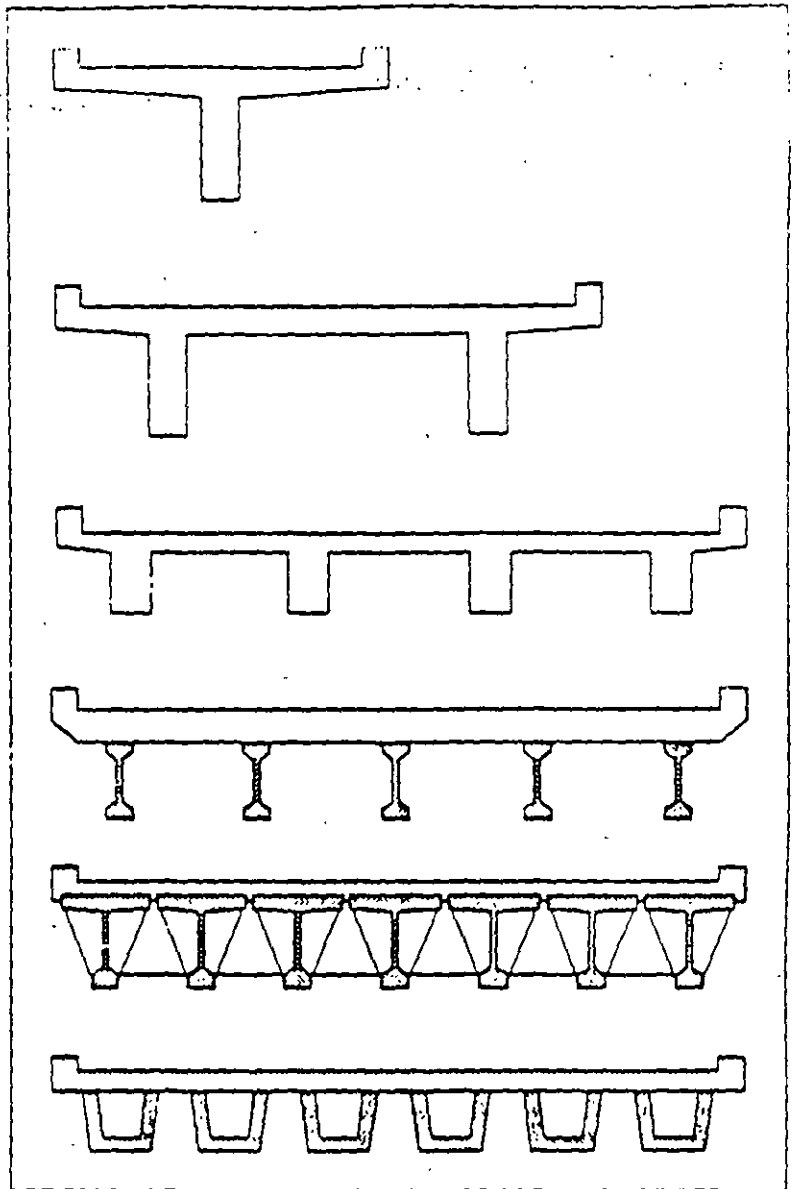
Sección transversal, tipo 11 - 14, Losa sobre vigas
